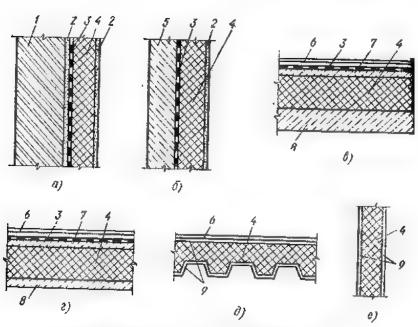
Схемы изоляции ограждающих конструкций зданий холодельнеков:
